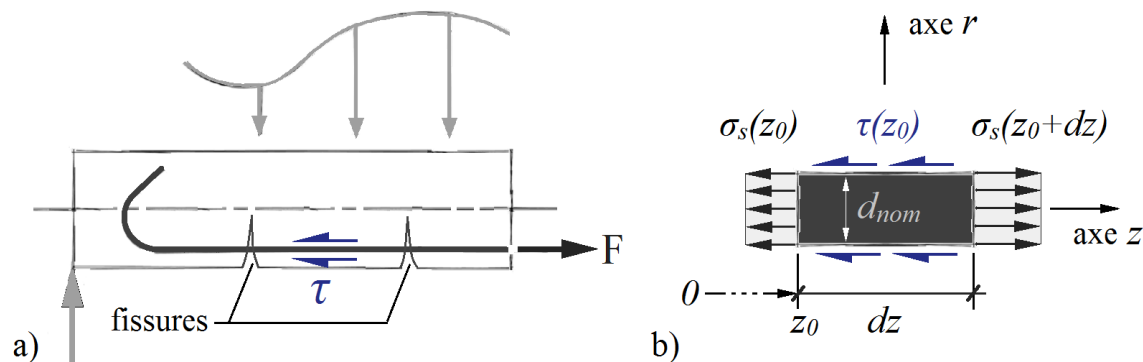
La contrainte d'adhérence : a) zone tendue d'une poutre fléchie, b) équilibre d'un tronçon d'armature.
